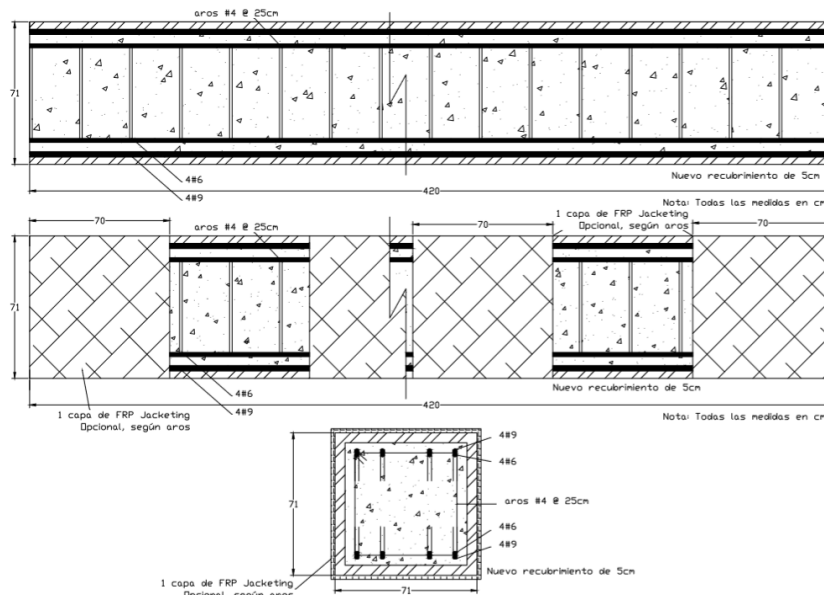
Detalle de la propuesta de reparación (arriba) en conjunto con una propuesta de colocado de FRP Jacketing en caso de que el acero por cortante presente corrosión (abajo) para el puente sobre quebrada El Fierro. Fuente: Elaboración propia.
